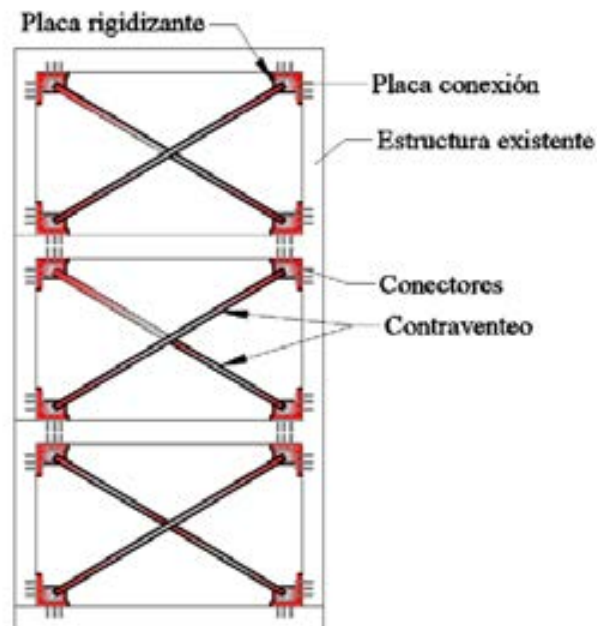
Rehabilitación con contraventeo en X en el plano de la estructura original, conectados mediante conectores
